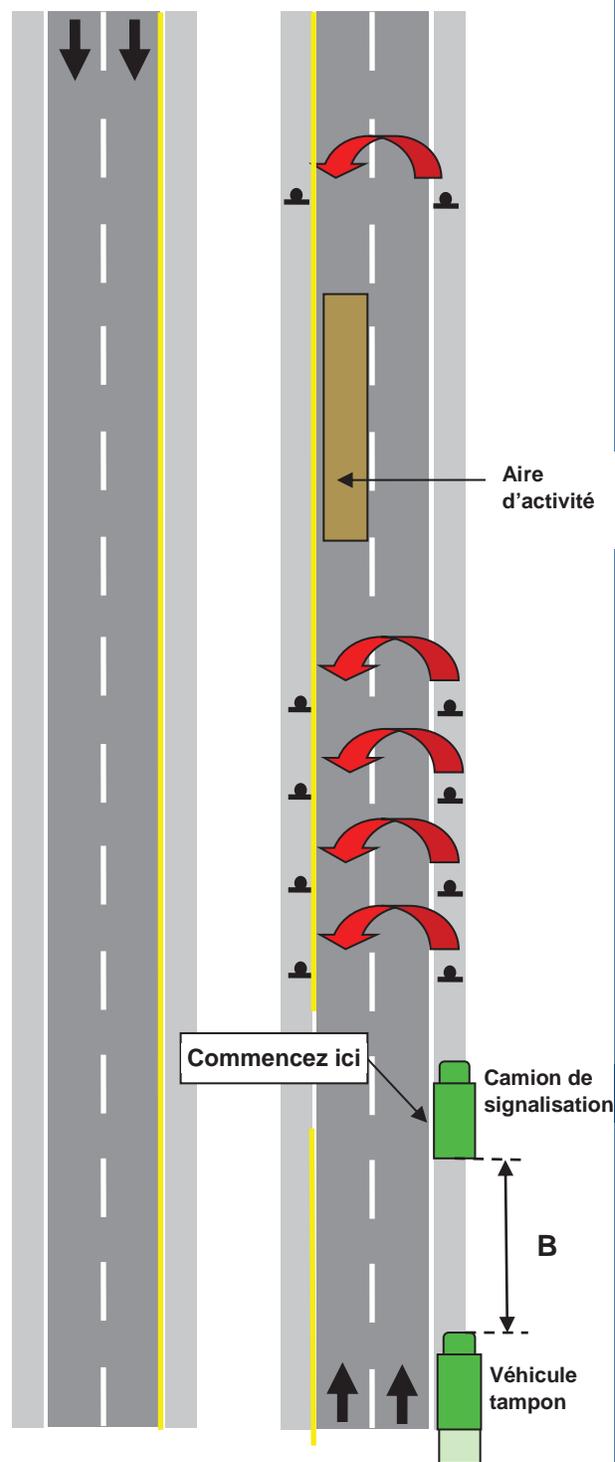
Installation des panneaux (routes à voies multiples à chaussées séparées)
